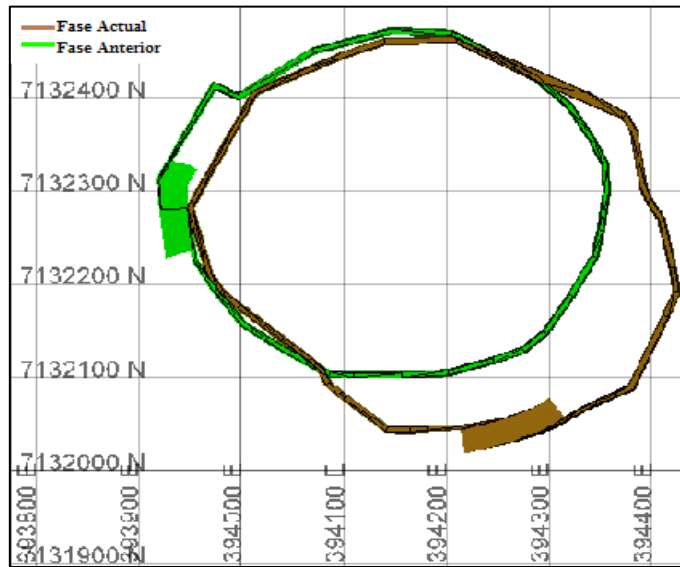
LGMM1Y Fase 4 - Vista en sección – Planta banco 1110
